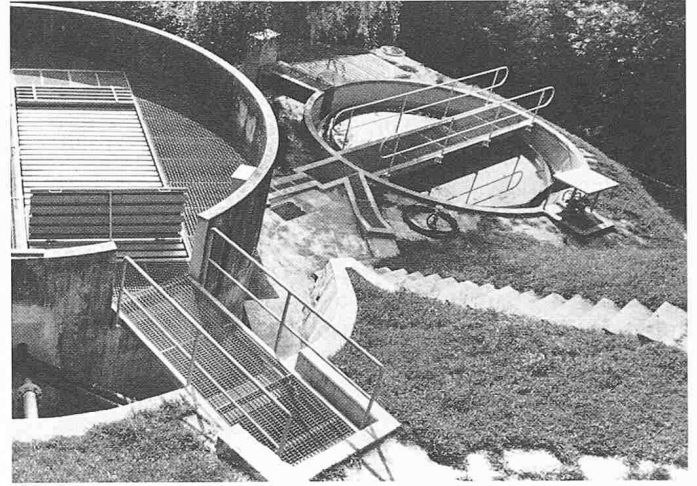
Weiterverwendung der bestehenden Bauten: Tauchtropfkörper, Nachklärbecken, Einbau Nachklärfilter
